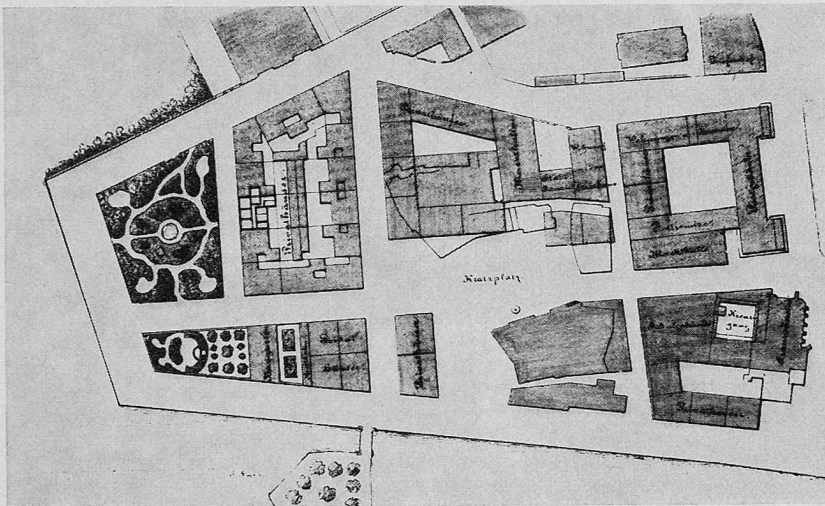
Projekt Karl Pestalozzi. Der Verfasser behielt die Knickung der Bahnhofstrasse nach Westen (im Plan oben) bei, obschon auch er den Kratzturm mit dem «Baugarten» beseitigen wollte. Er plante dafür einen neuen Baugarten als Gesellschaftslokal beim Bauschänzli. Anstelle der Abteigebäude sah Pestalozzi ein Schulhaus vor. Die Stadtverwaltung sollte im Gebiet des ehemaligen Kappelerhofes untergebracht werden
